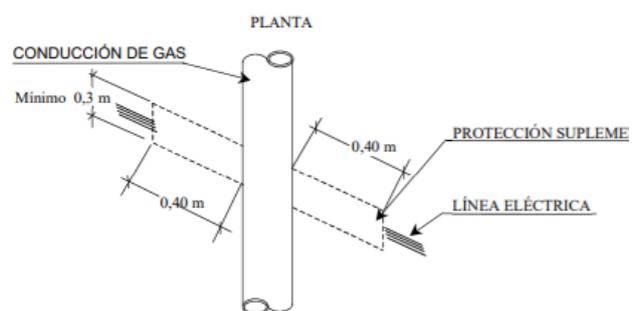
Planta cruzamiento con gas. Fuente MT 2.31.01
